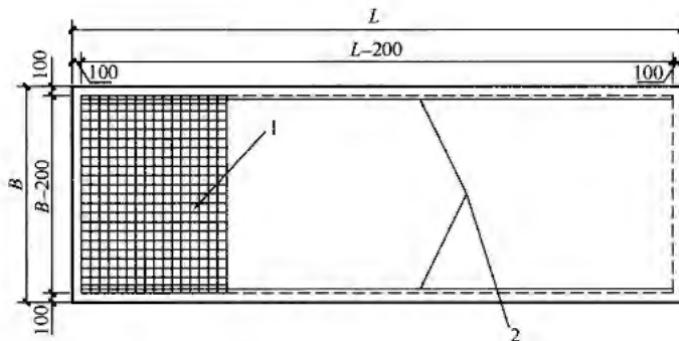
钢筋焊接网和边缘补强钢筋示例
